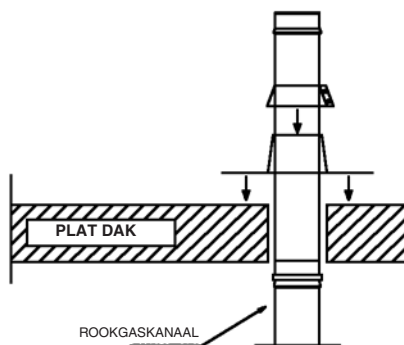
B Montageschema dakdoorvoer plat dak met stormkraag
